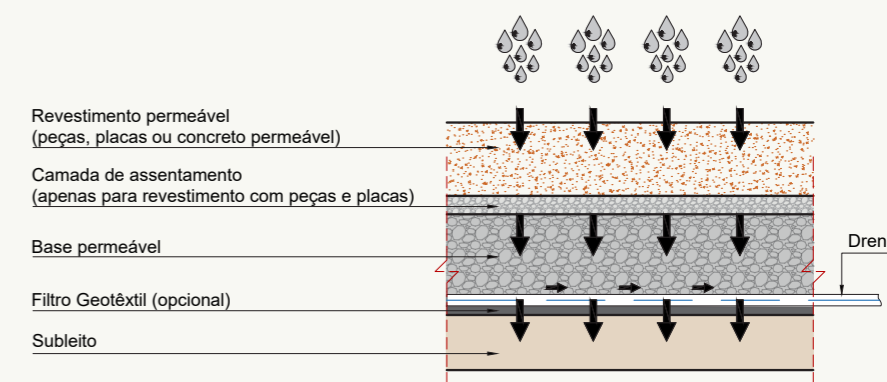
Infiltração parcial no pavimento permeável. Fonte: ABNT NBR 16416.
